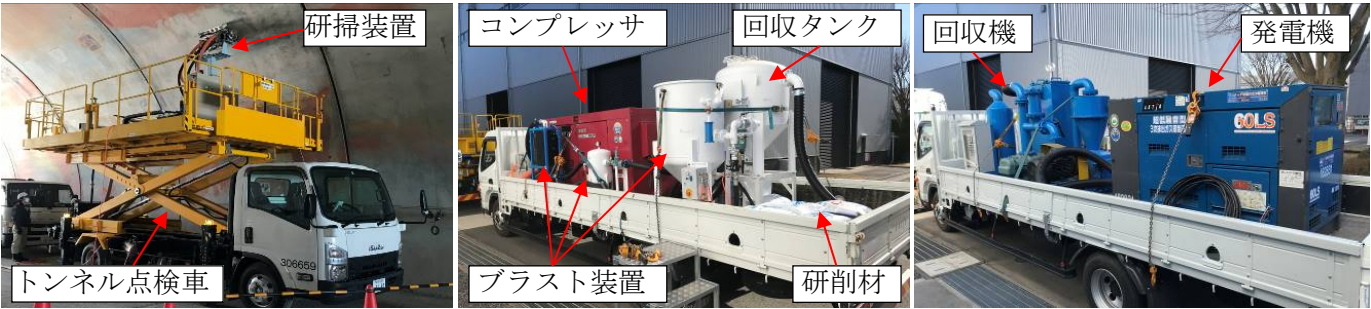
トンネル点検車と研掃装置 写真-2 4トン車A及び付帯装置 写真-3 4トン車B及び付帯装置
